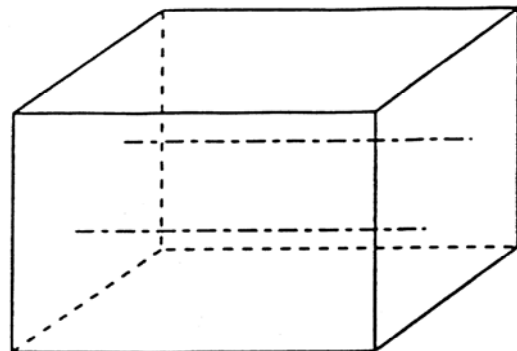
Modellierung des Verbundes zwischen Beton und Bewehrungsstahl mit Federelementen
